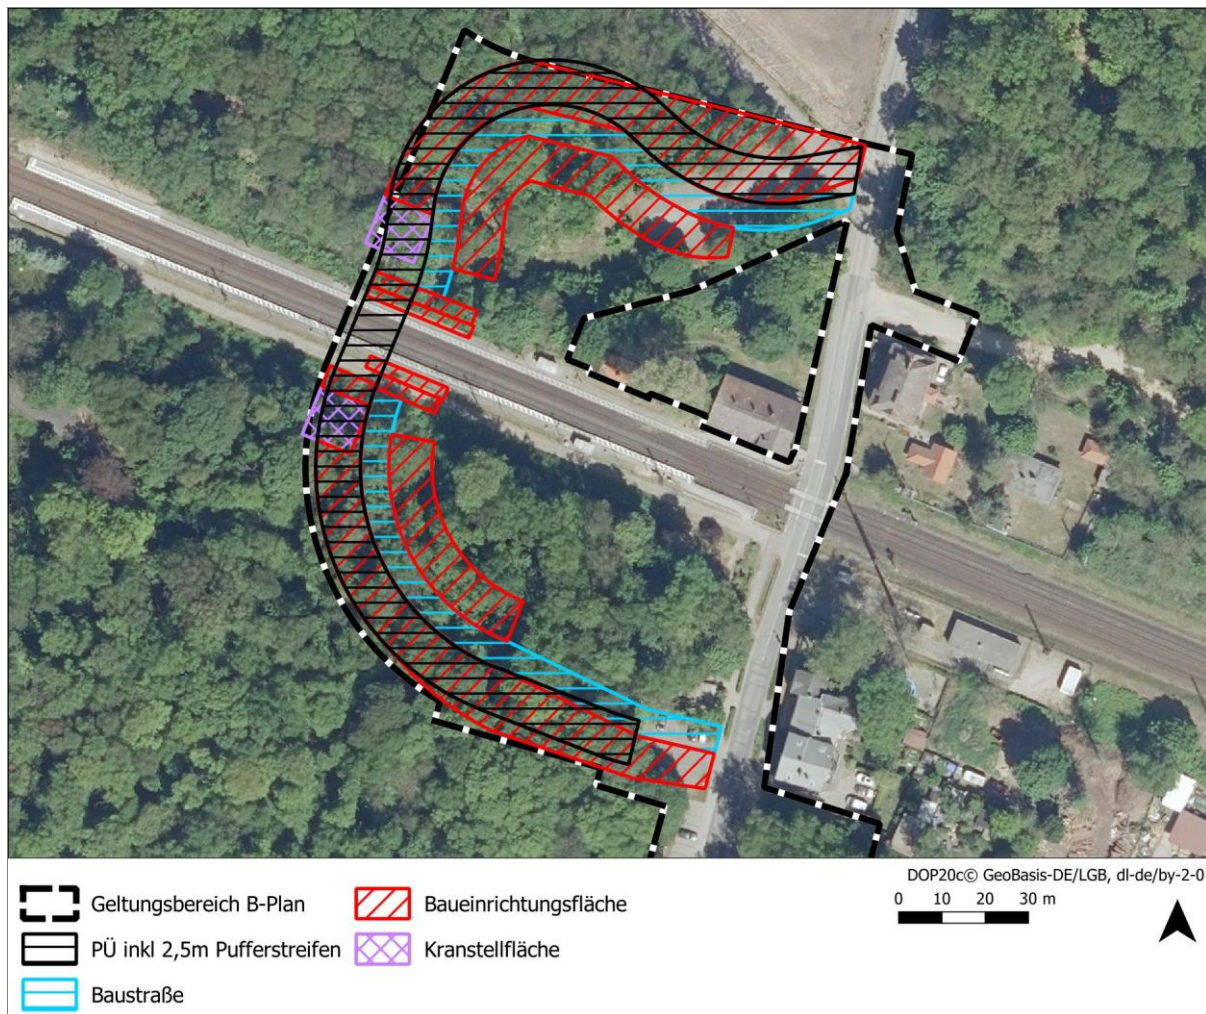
Plan der für die Herstellung der Personenüberführung (PÜ) notwendigen Baustraßen, Baueinrichtungs- und Kranstellflächen
